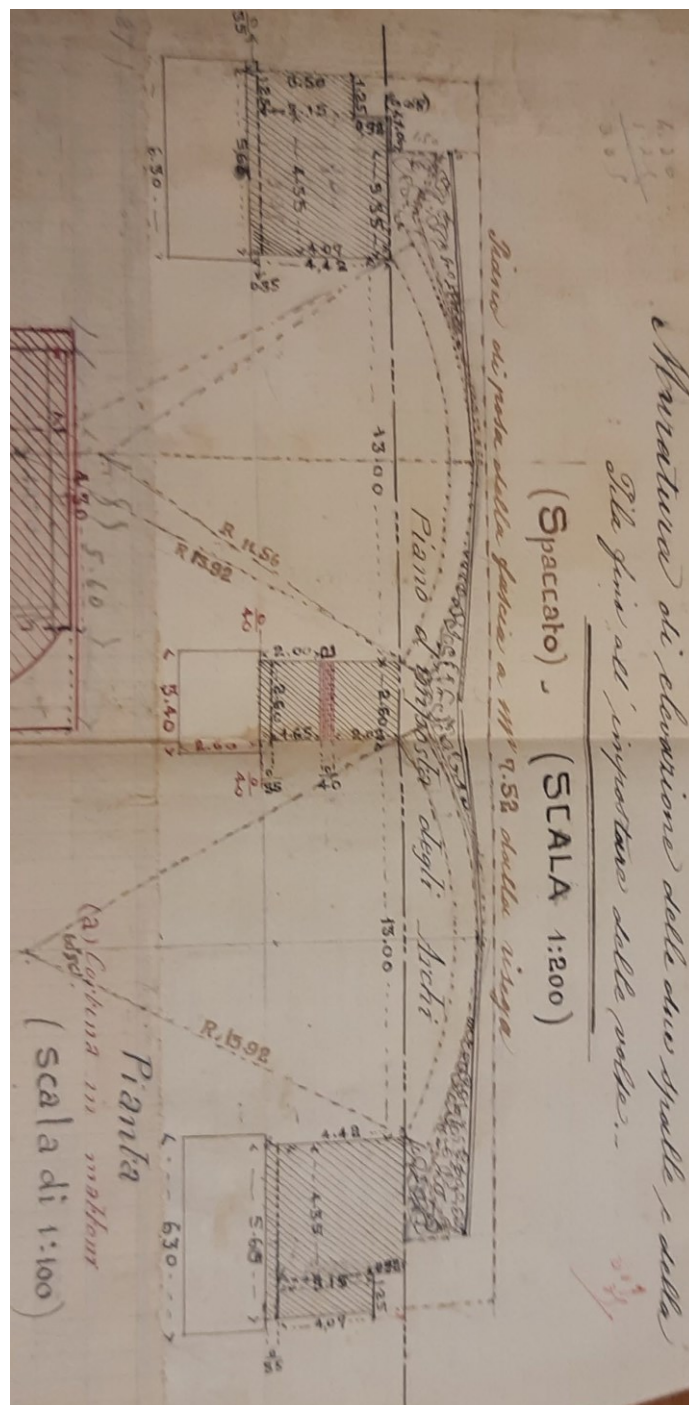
Estratto dei documenti d'archivio, sezione del ponte
